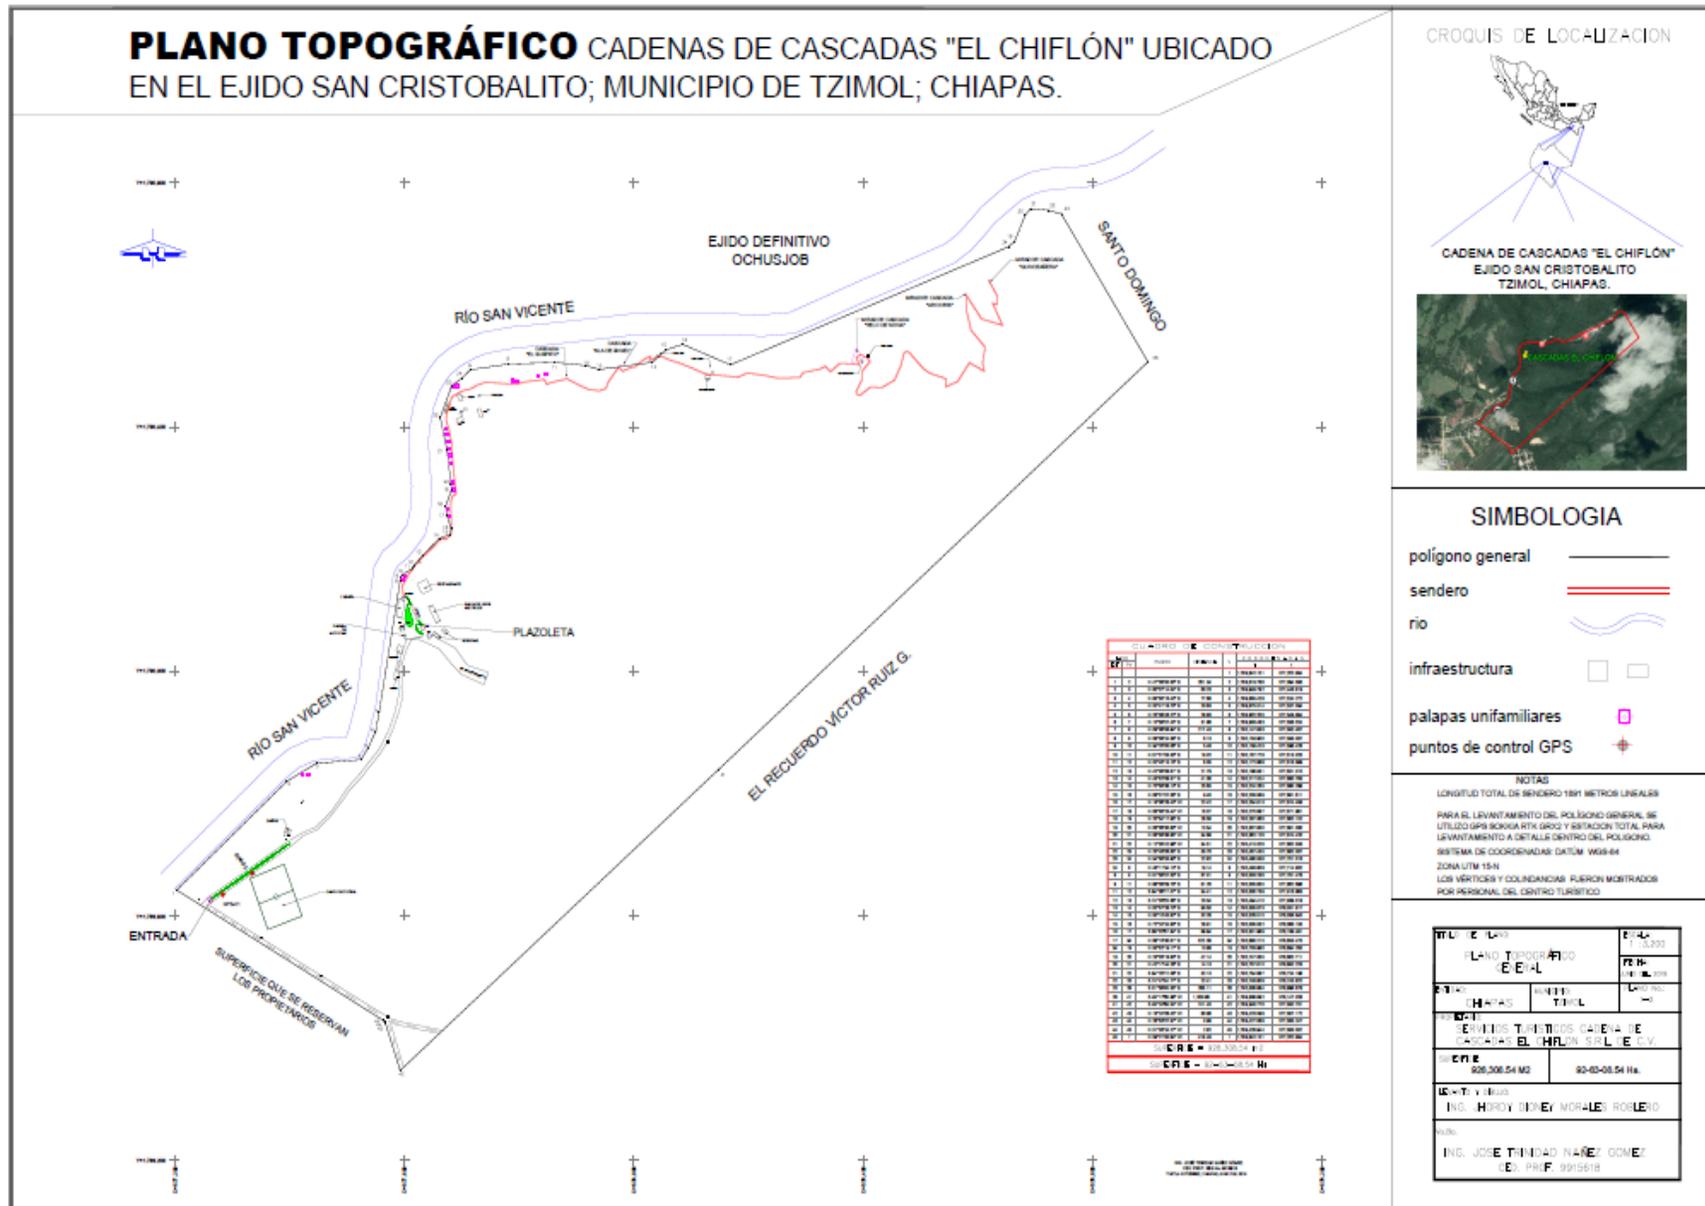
Plano de Conjunto de la distribución de las Obras del Proyecto. (Se anexa Plano).
